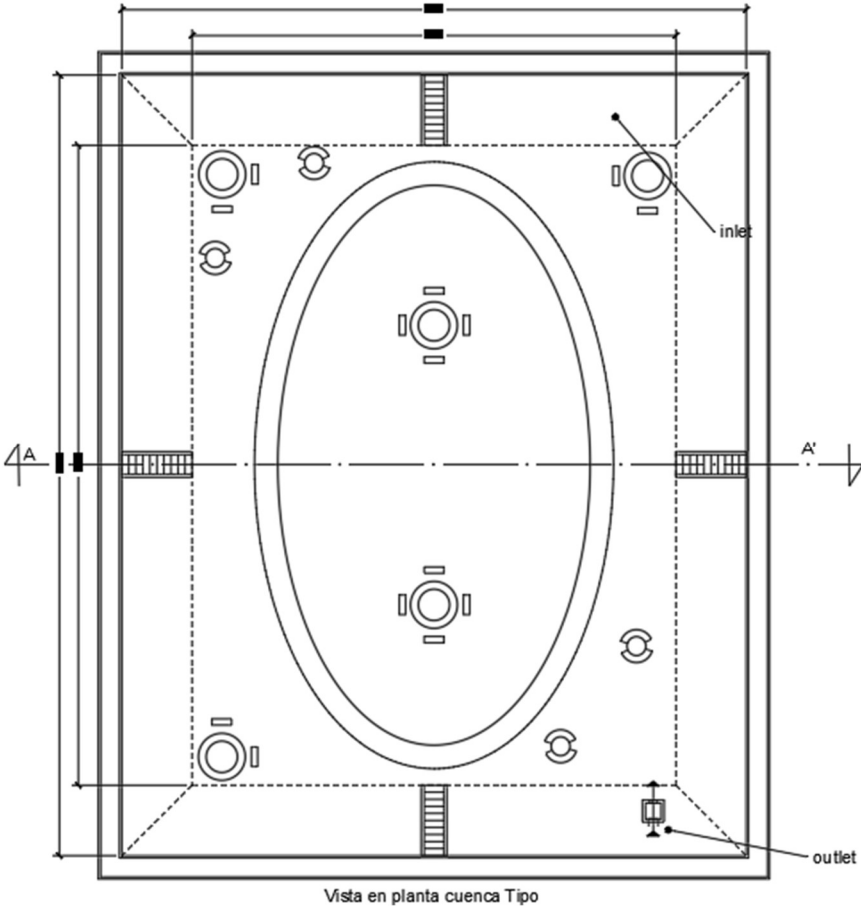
Vista en planta de una cuenca de retención tipo
